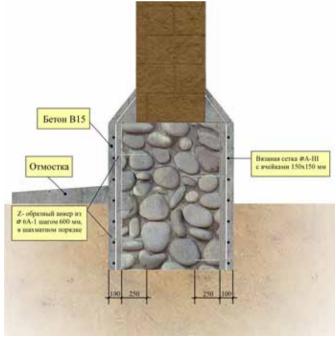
Усиление фундамента из бутового камня железобетонными слоями
